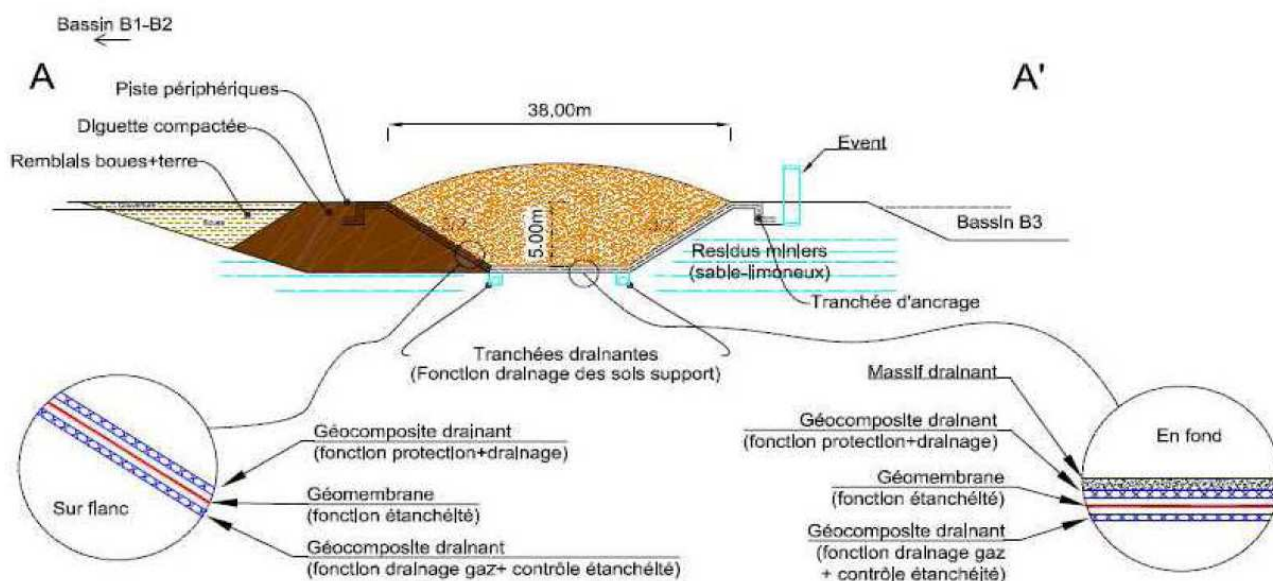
Coupe schématique du dispositif d'étanchéité/drainage de l'alvéole sur B2 (pièce 2, page 30)
